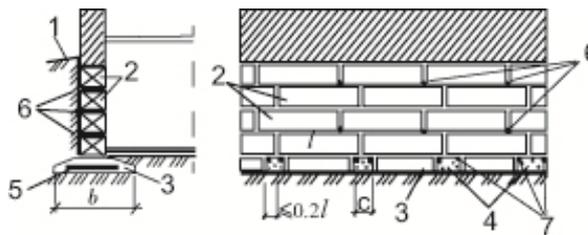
Армирование фундамента по периметру сооружения \
